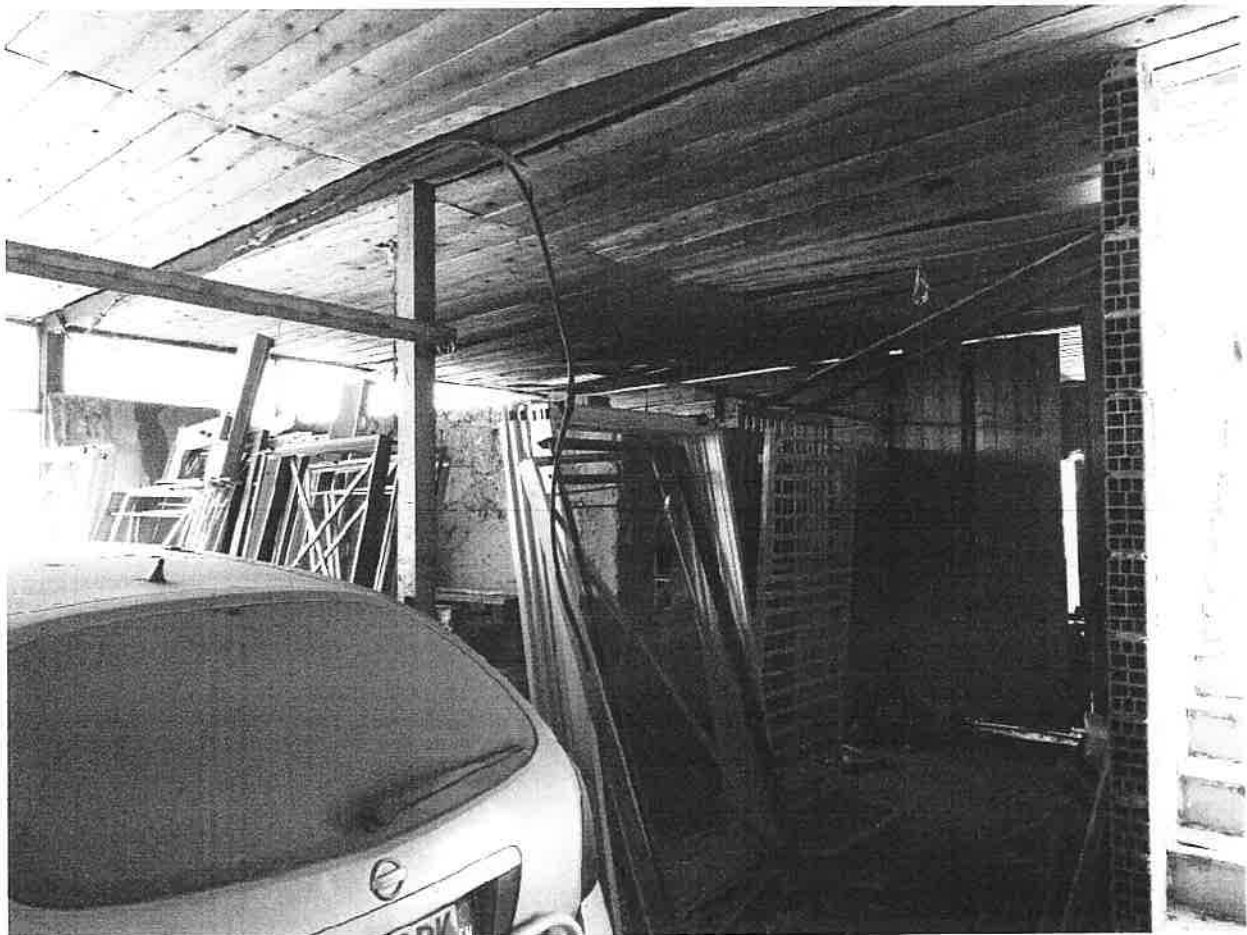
Tettoia con manufatto in muratura all'interno ricadente nella part. 946
